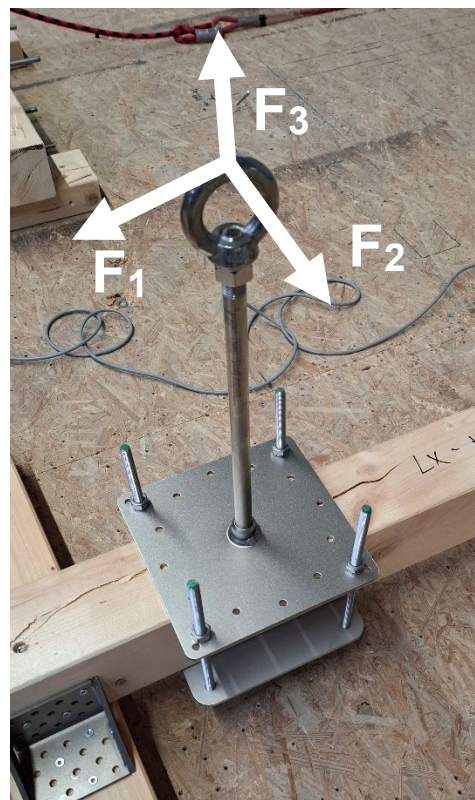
Prüfaufbau 8, Anschlagereinrichtung,
